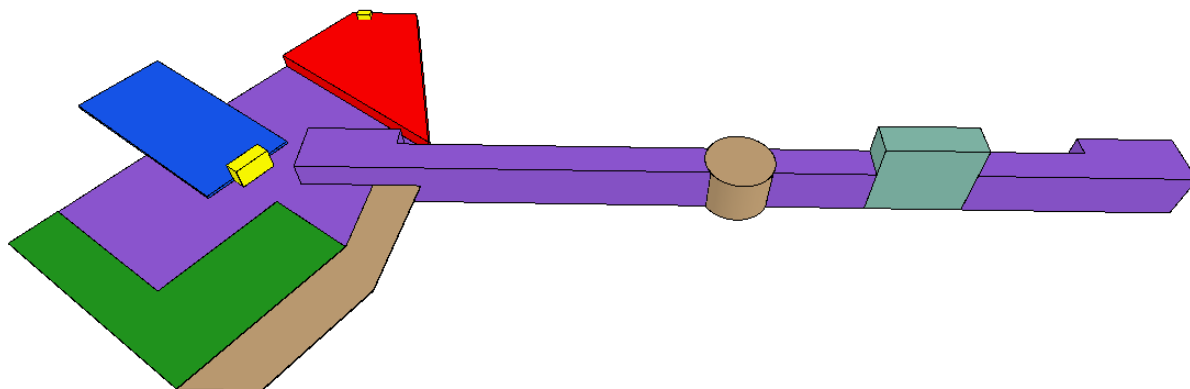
Plano de Massas. Fonte: Autoria própria.
